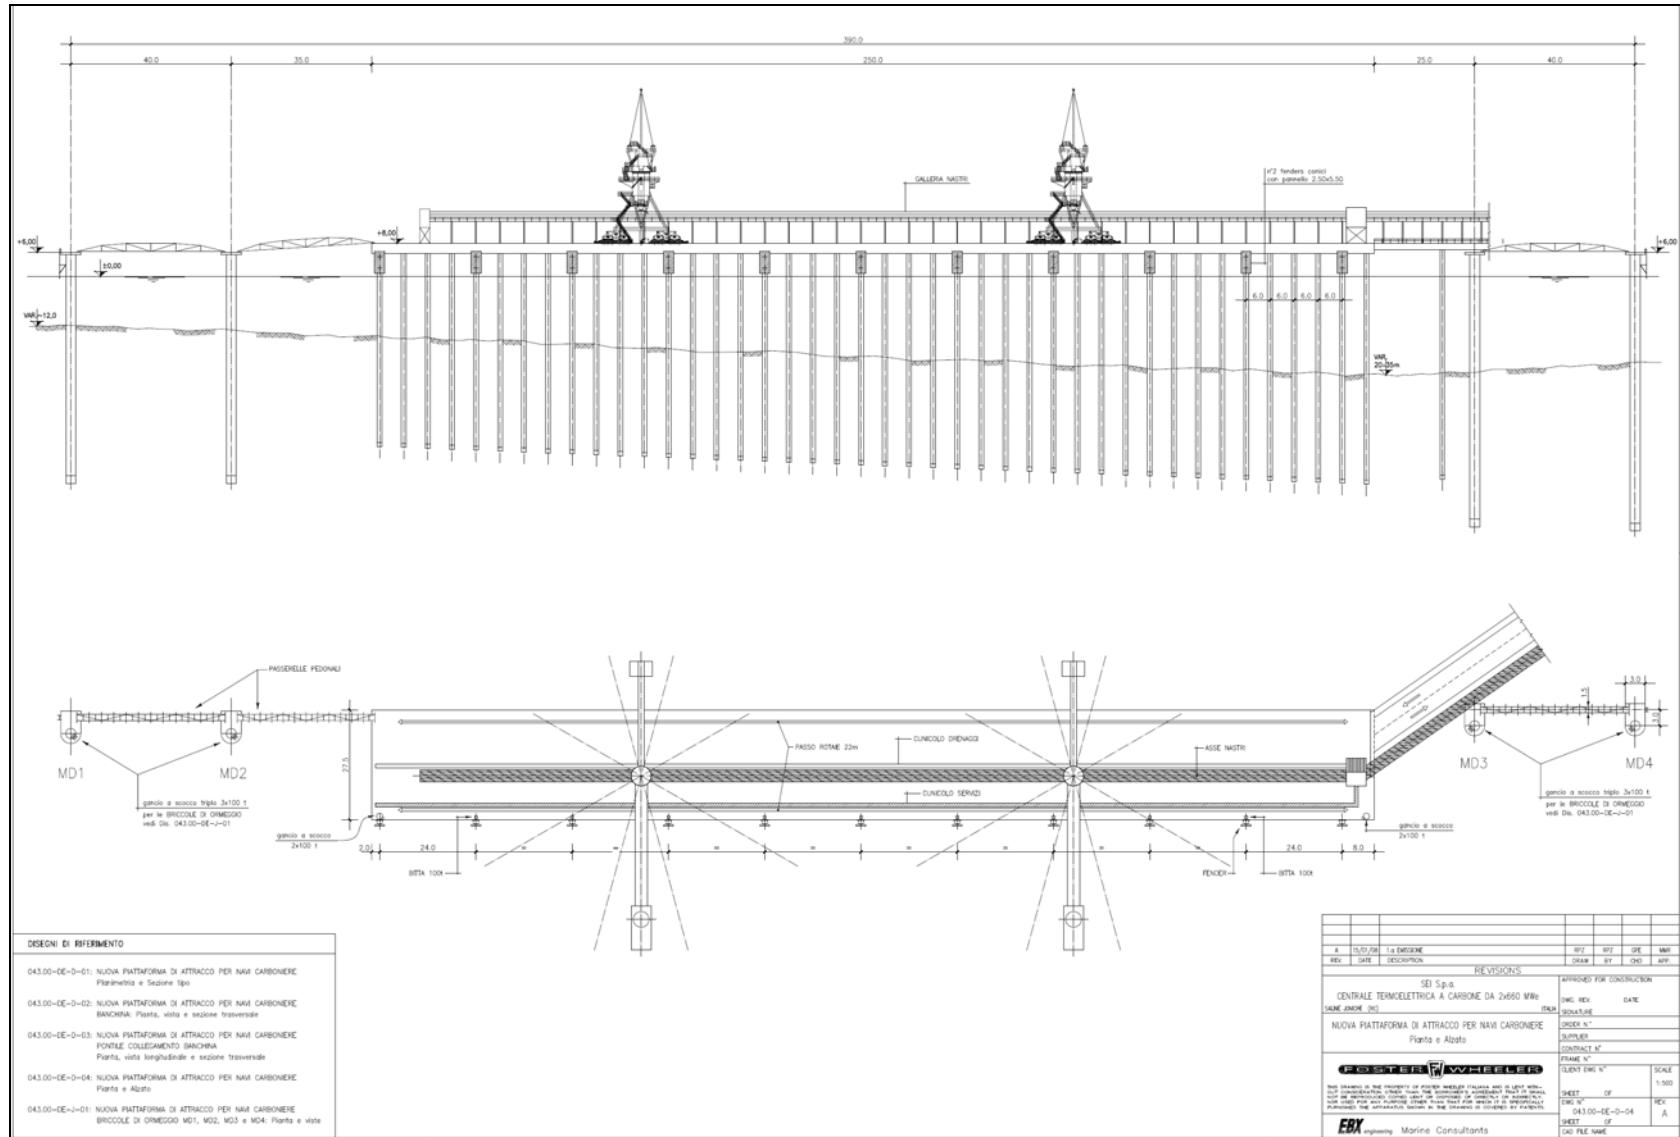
Prospetto generale del pontile carboniere (Estratto dalla Tavola di Progetto n. 043_00-DE-D-04)
